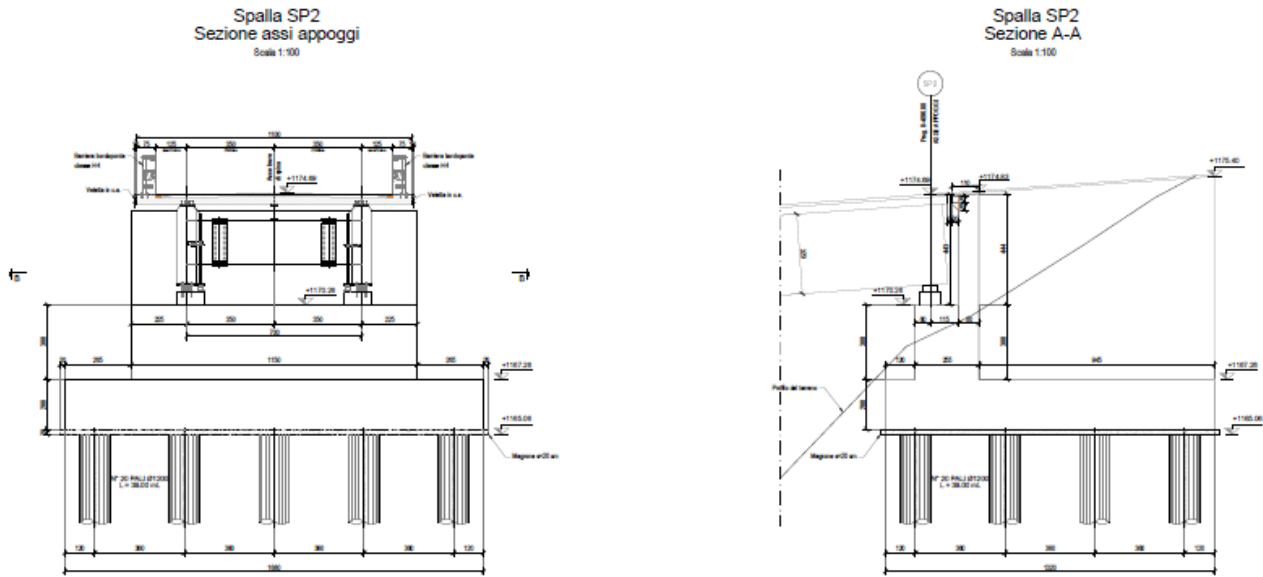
Ponte Bigontina - Carpenteria spalla 2
